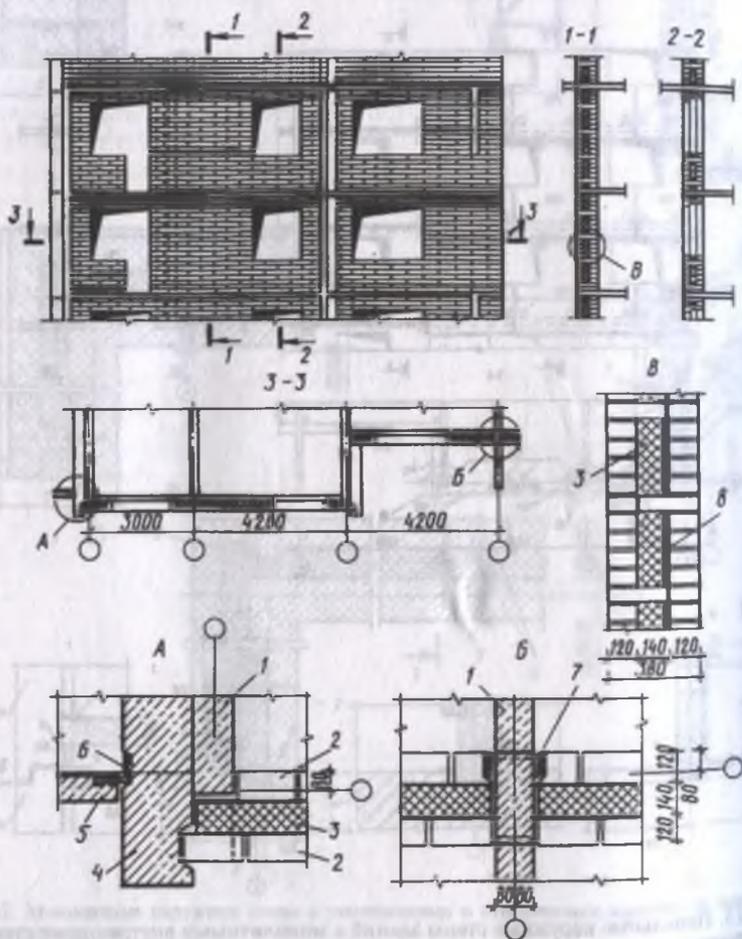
Кирпичная наружная стена здания с монолитными внутренними стенами и перекрытиями (фрагмент фасада и узлы):
